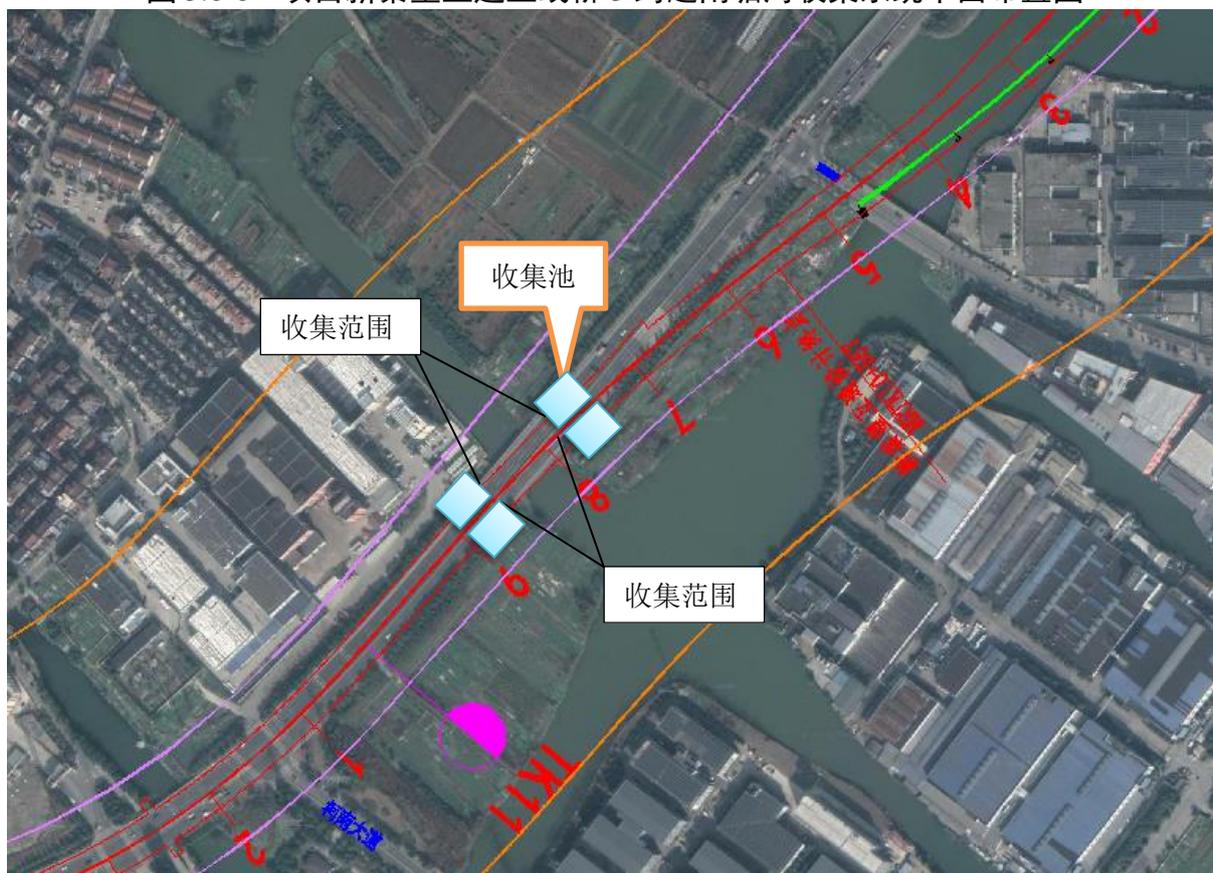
项目湖安路高架主线桥 3 跨越南塘河收集系统平面布置图
